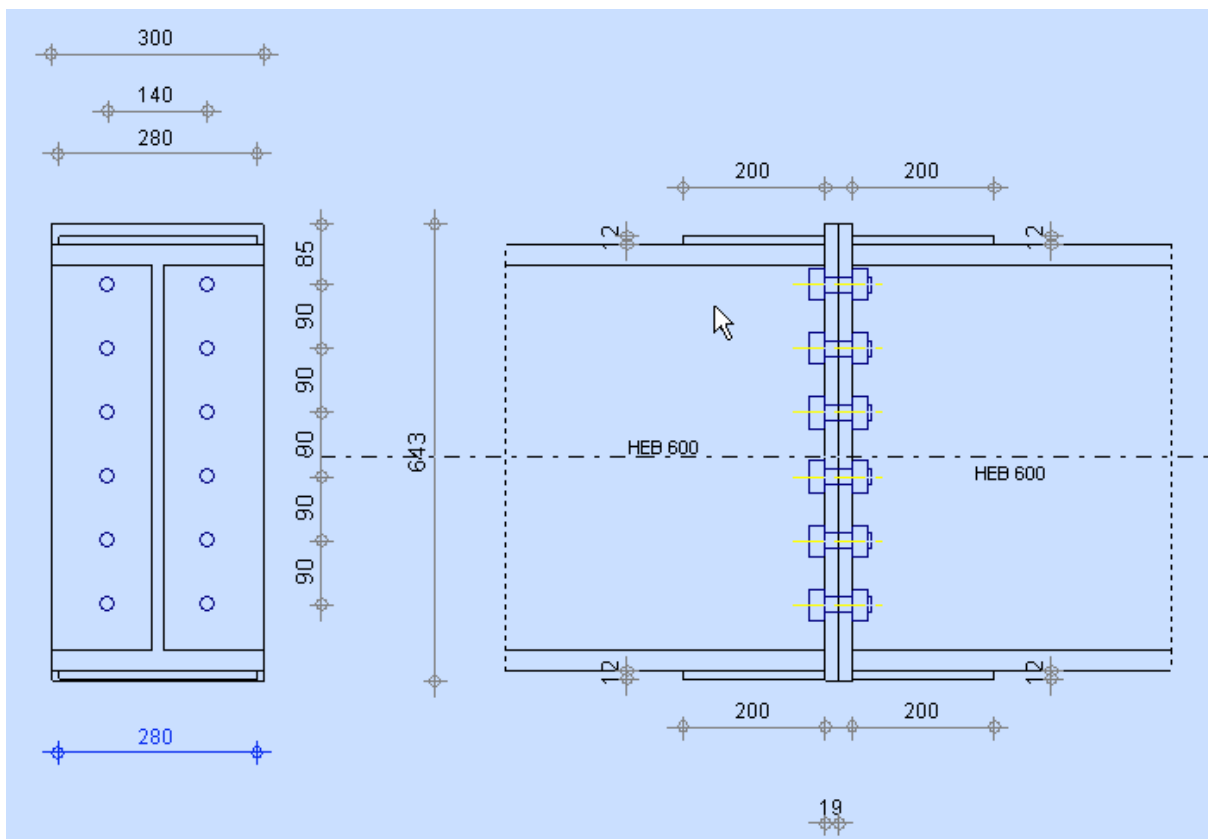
Schéma d'assemblage poteau – poteau avec la distribution des boulons
